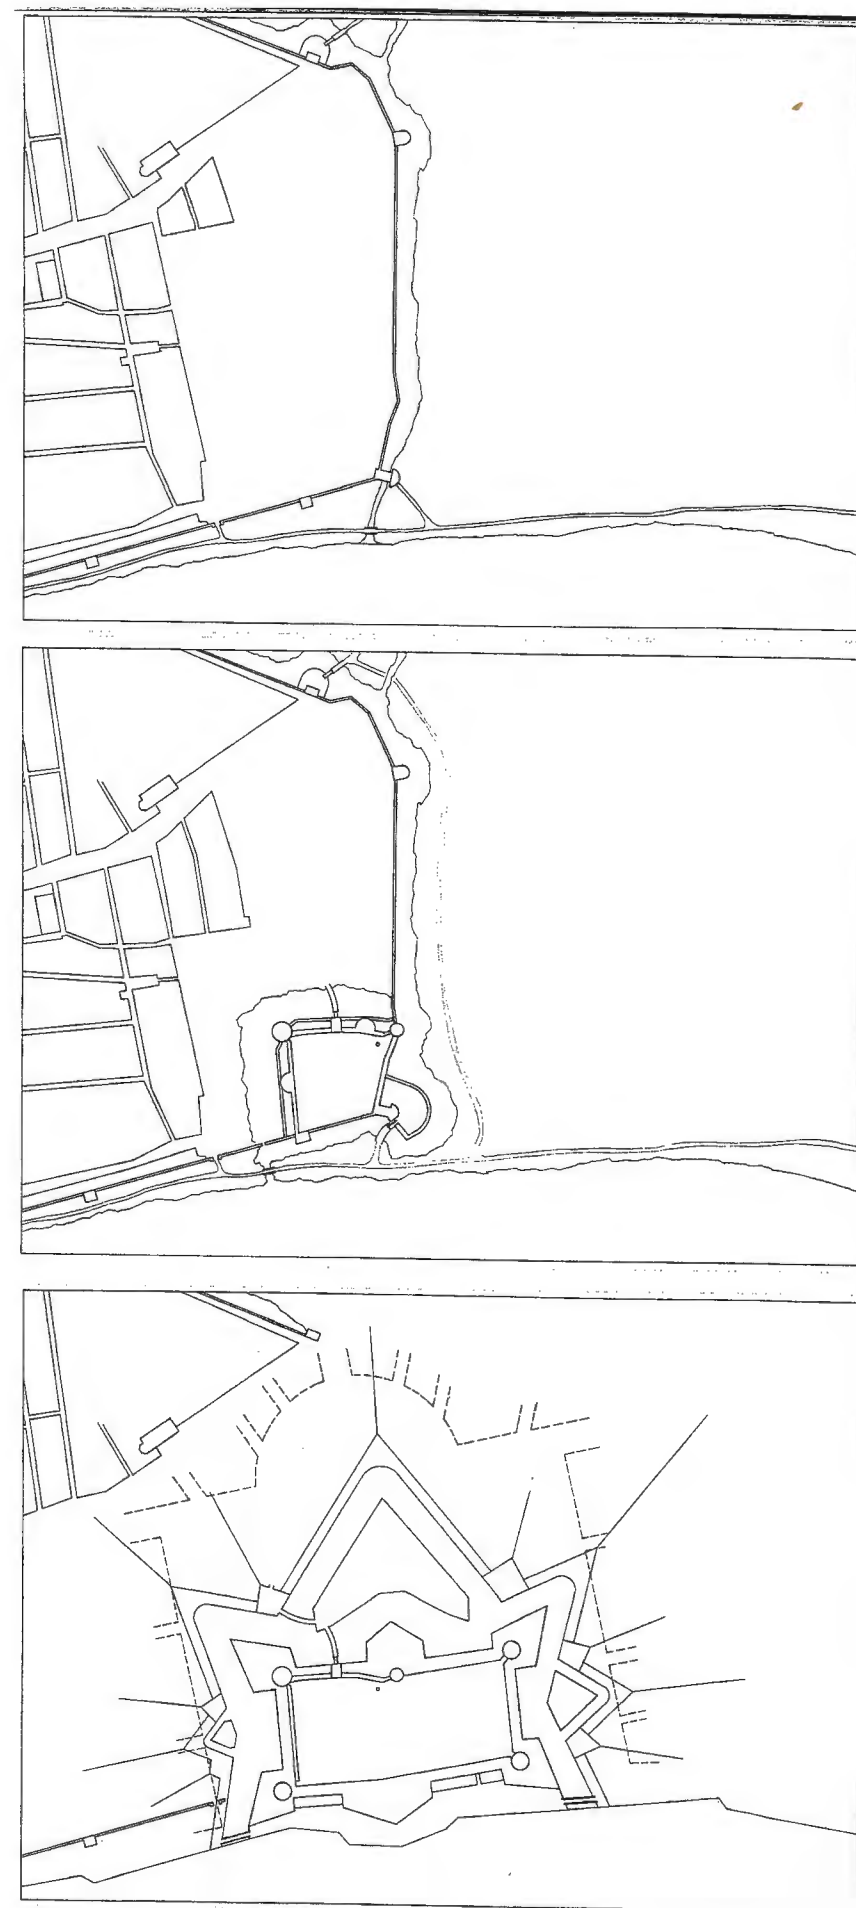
Le château Trompette, plan des états successifs par Pierre Lacour (1818).
